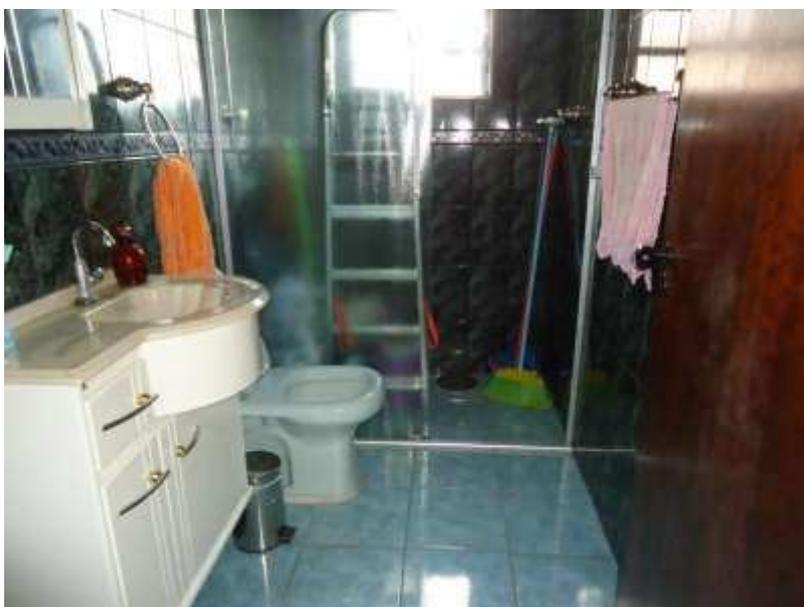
Detalhe interno da edificação – Pav. Inferior – Banho Social
